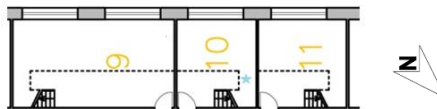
Pianta ufficio 10. Il posizionamento della centralina è indicato dalla stellina celeste.
